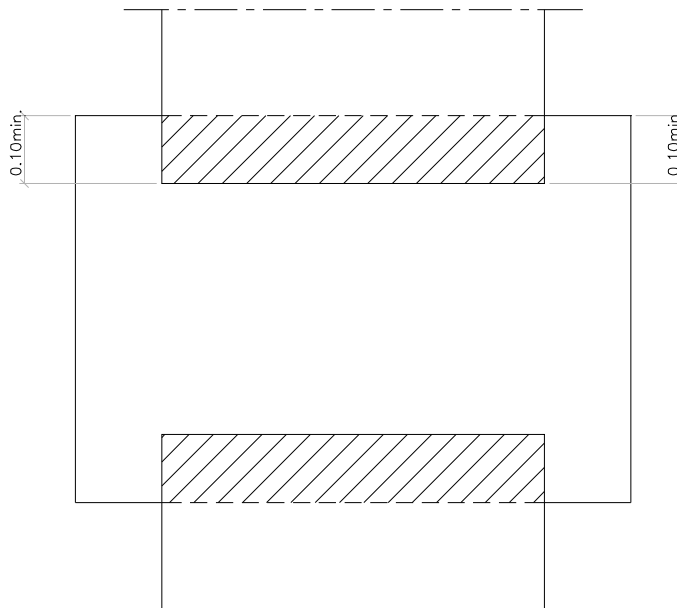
Joint plat sur terrasse accessible aux piétons, raccordement sur une étanchéité bicouche bitume modifié
